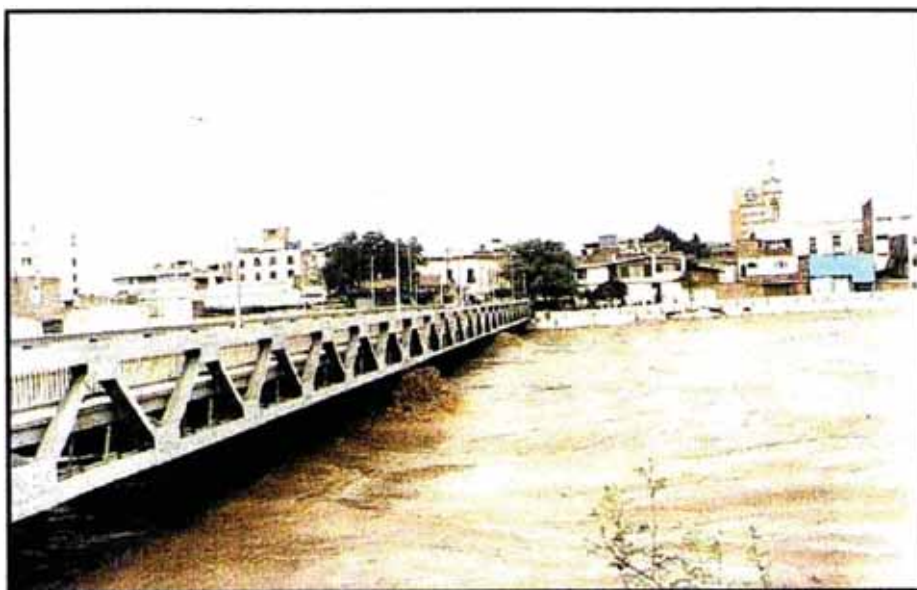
Puente Sánchez Cerro, caudal del río 10 m³/s (20.11.98)
